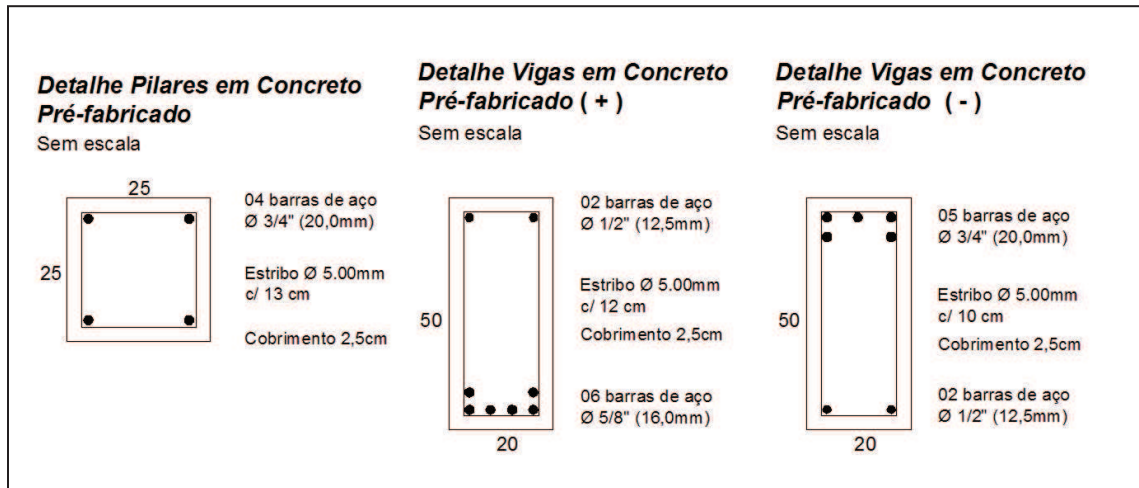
Detalhe seção vigas e pilares - análise dinâmica sem tirantes.
